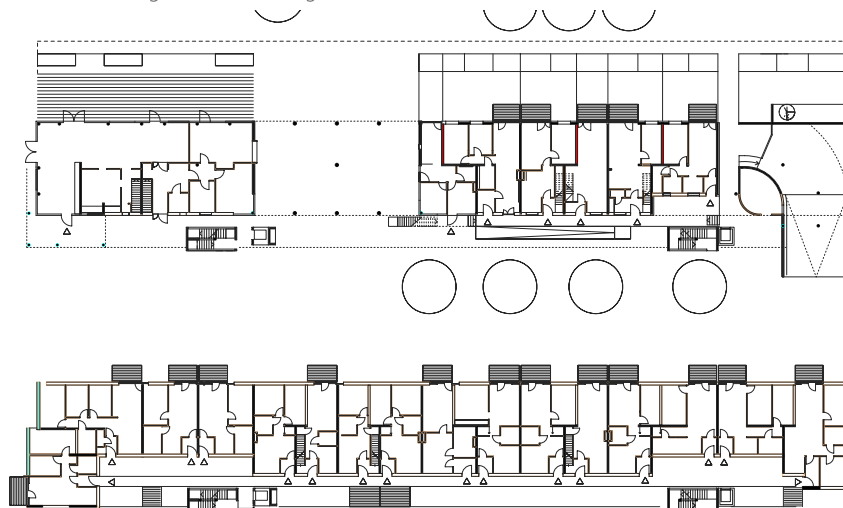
Grundriss EG und DG »Wohnanlage Ackermannbogen«
